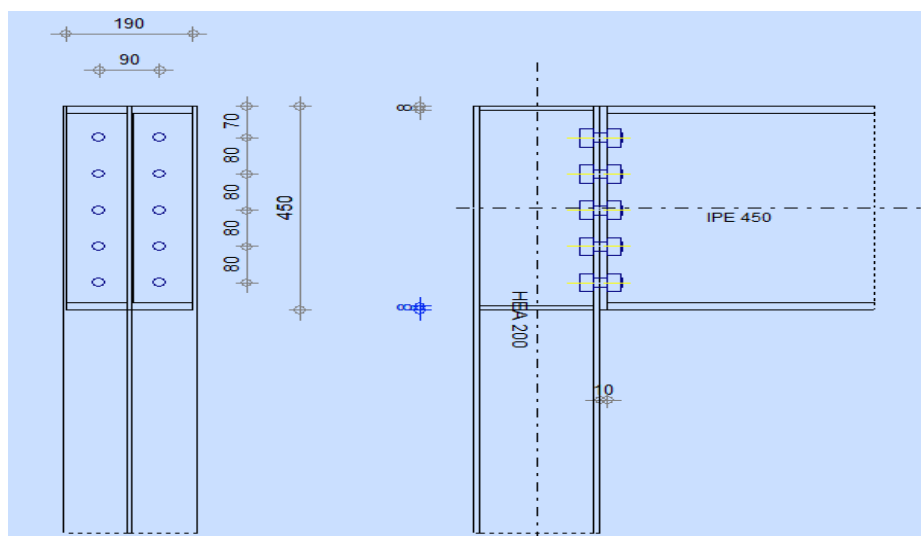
schéma assemblage poteau-poutre principale.
